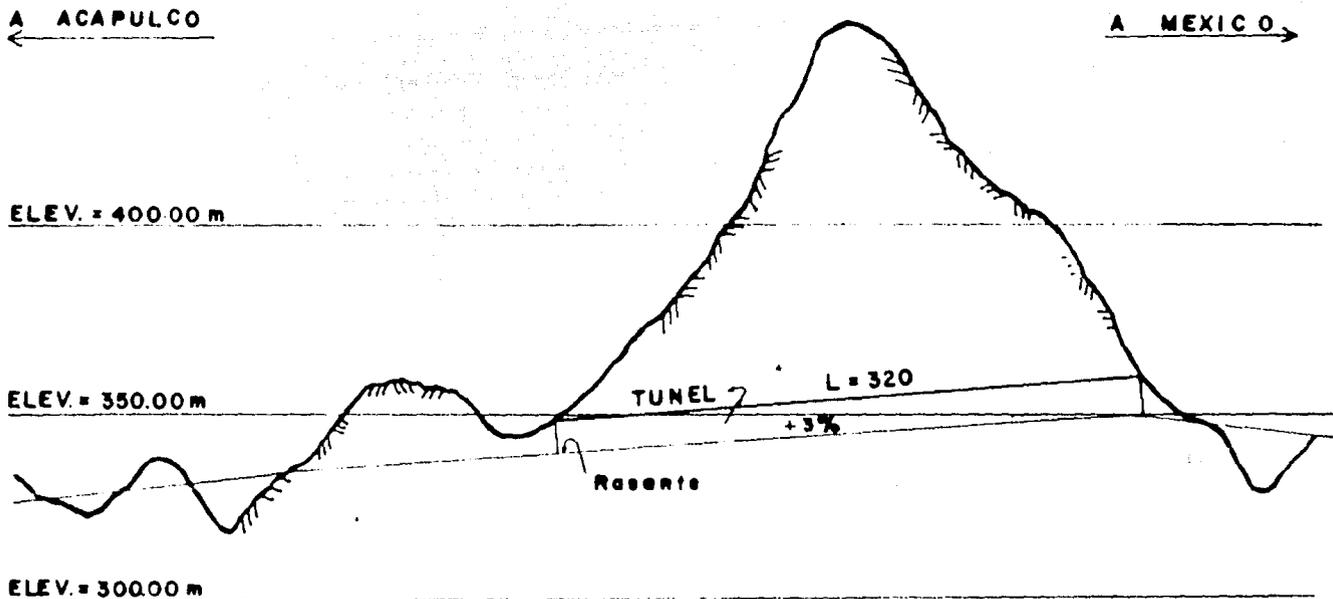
CORTE LONGITUDINAL, TUNEL TIERRA COLORADA
